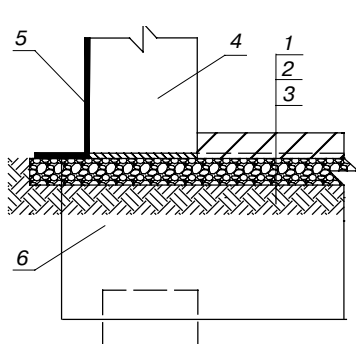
Фрагментированный барьер (плита пола, опирающаяся на ростверк): 1 – монолитный, армированный дорожной сеткой бетон; 2 – слой щебня, пролитый расплавленным битумом до полного насыщения; 3 – уплотненный грунт; 4 – наружная цокольная панель, опирающаяся углами на балки ростверка; 5 – гидроизоляция из обмазочного или рулонного материала; 6 – поперечная балка незамкнутого по периметру ростверка
